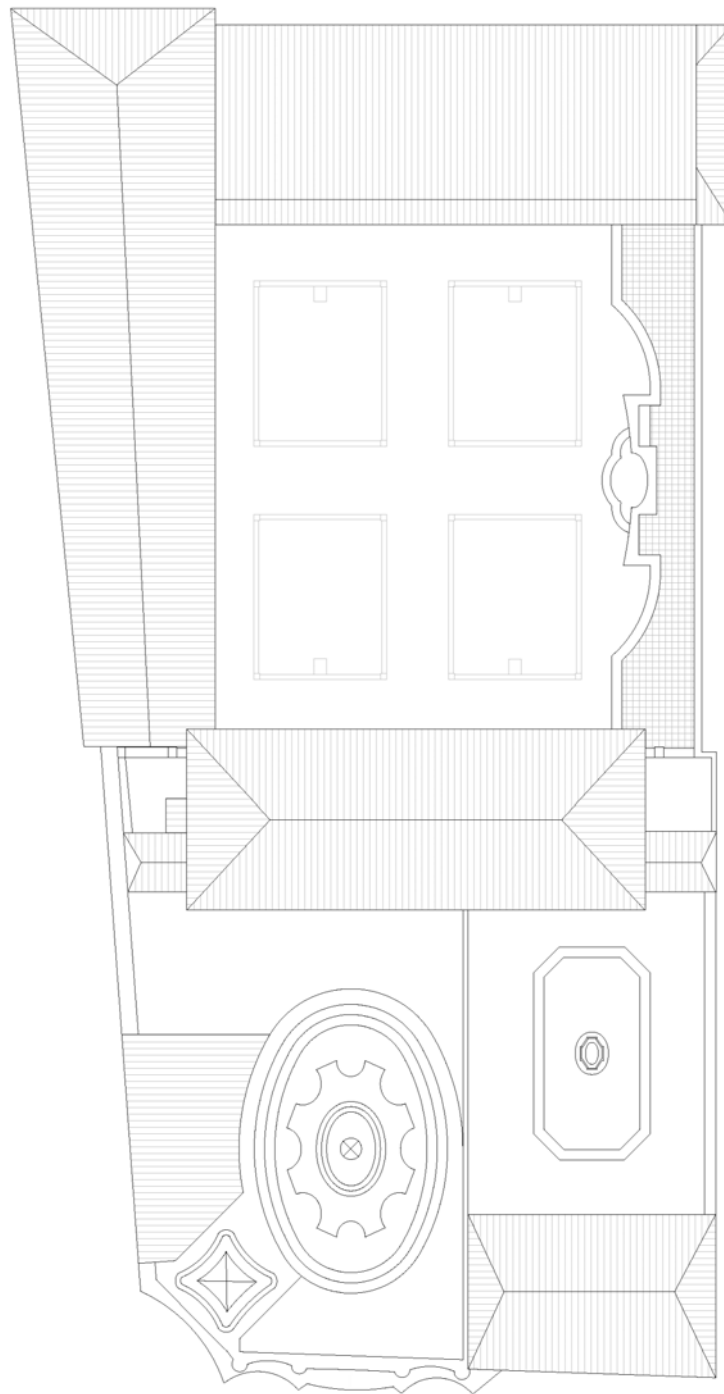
Dibujo de la autora. Planta de cubiertas.
